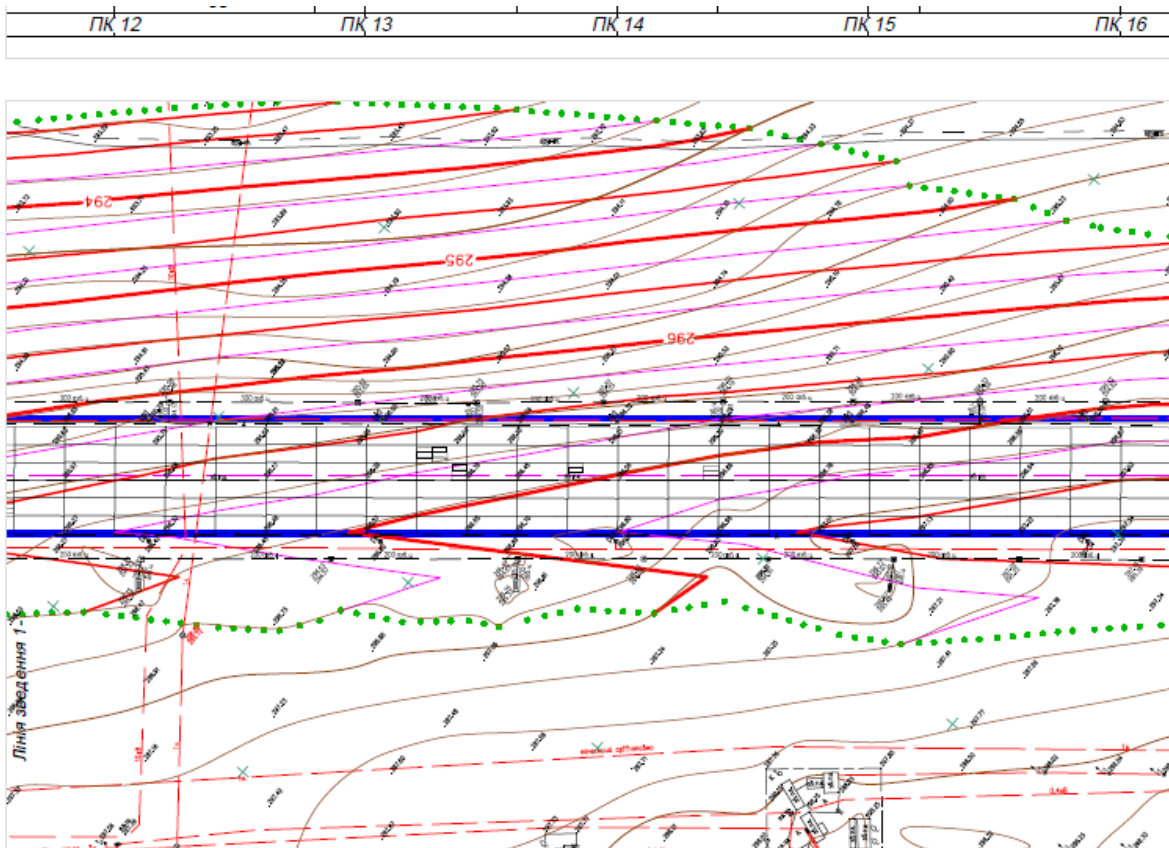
Детальний фрагмент плану ПК 12-ПК 16
